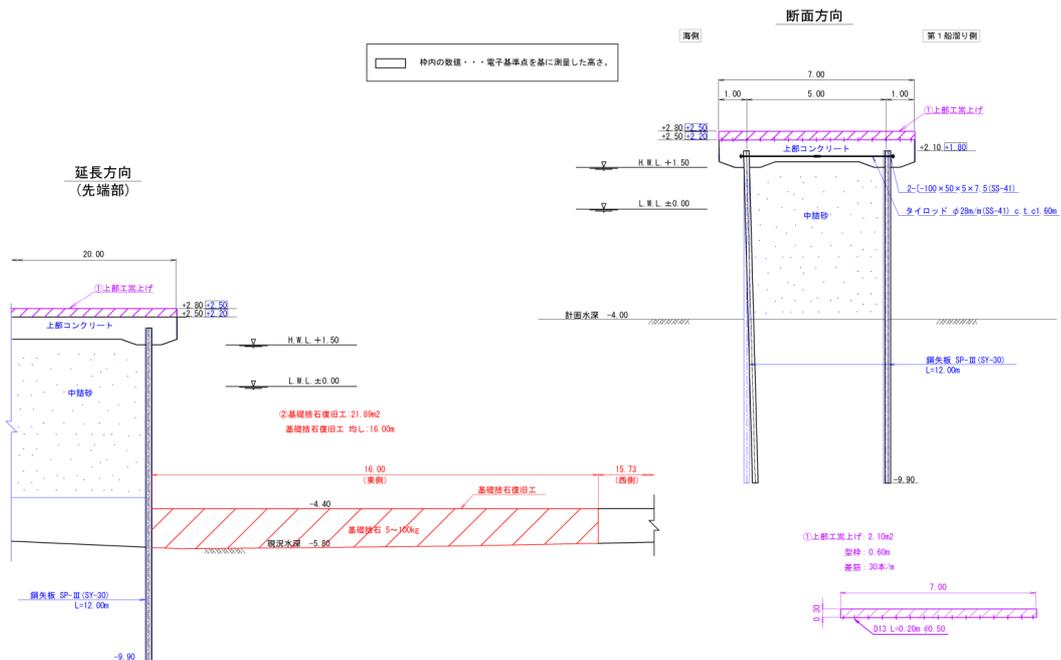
No.14 日立港区_第5埠頭地区第1船だまりの東断面図(復旧後)
